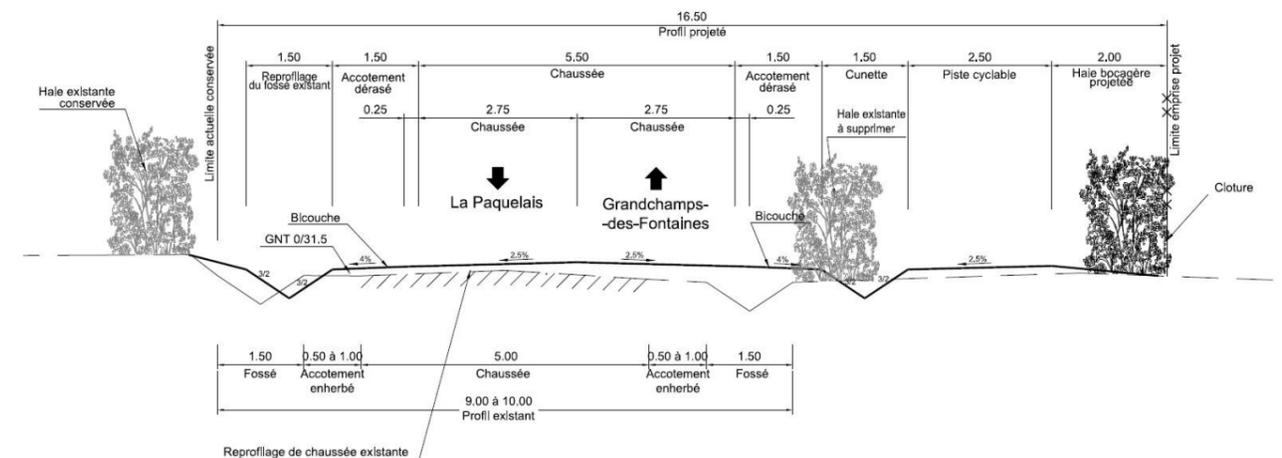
Section courante - Profil en travers de la RD326 – Elargissement côté droit
